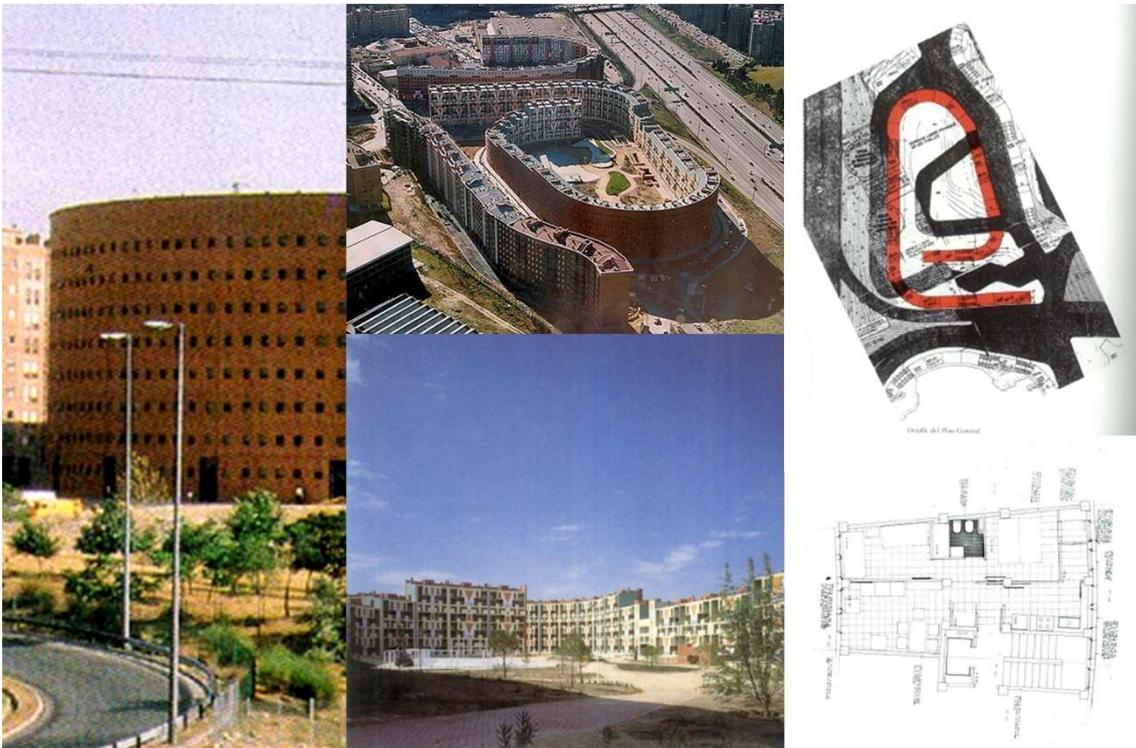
Fachada, vista aérea, patio, esquema de funcionamiento y planta tipo de 2 dormitorios.
